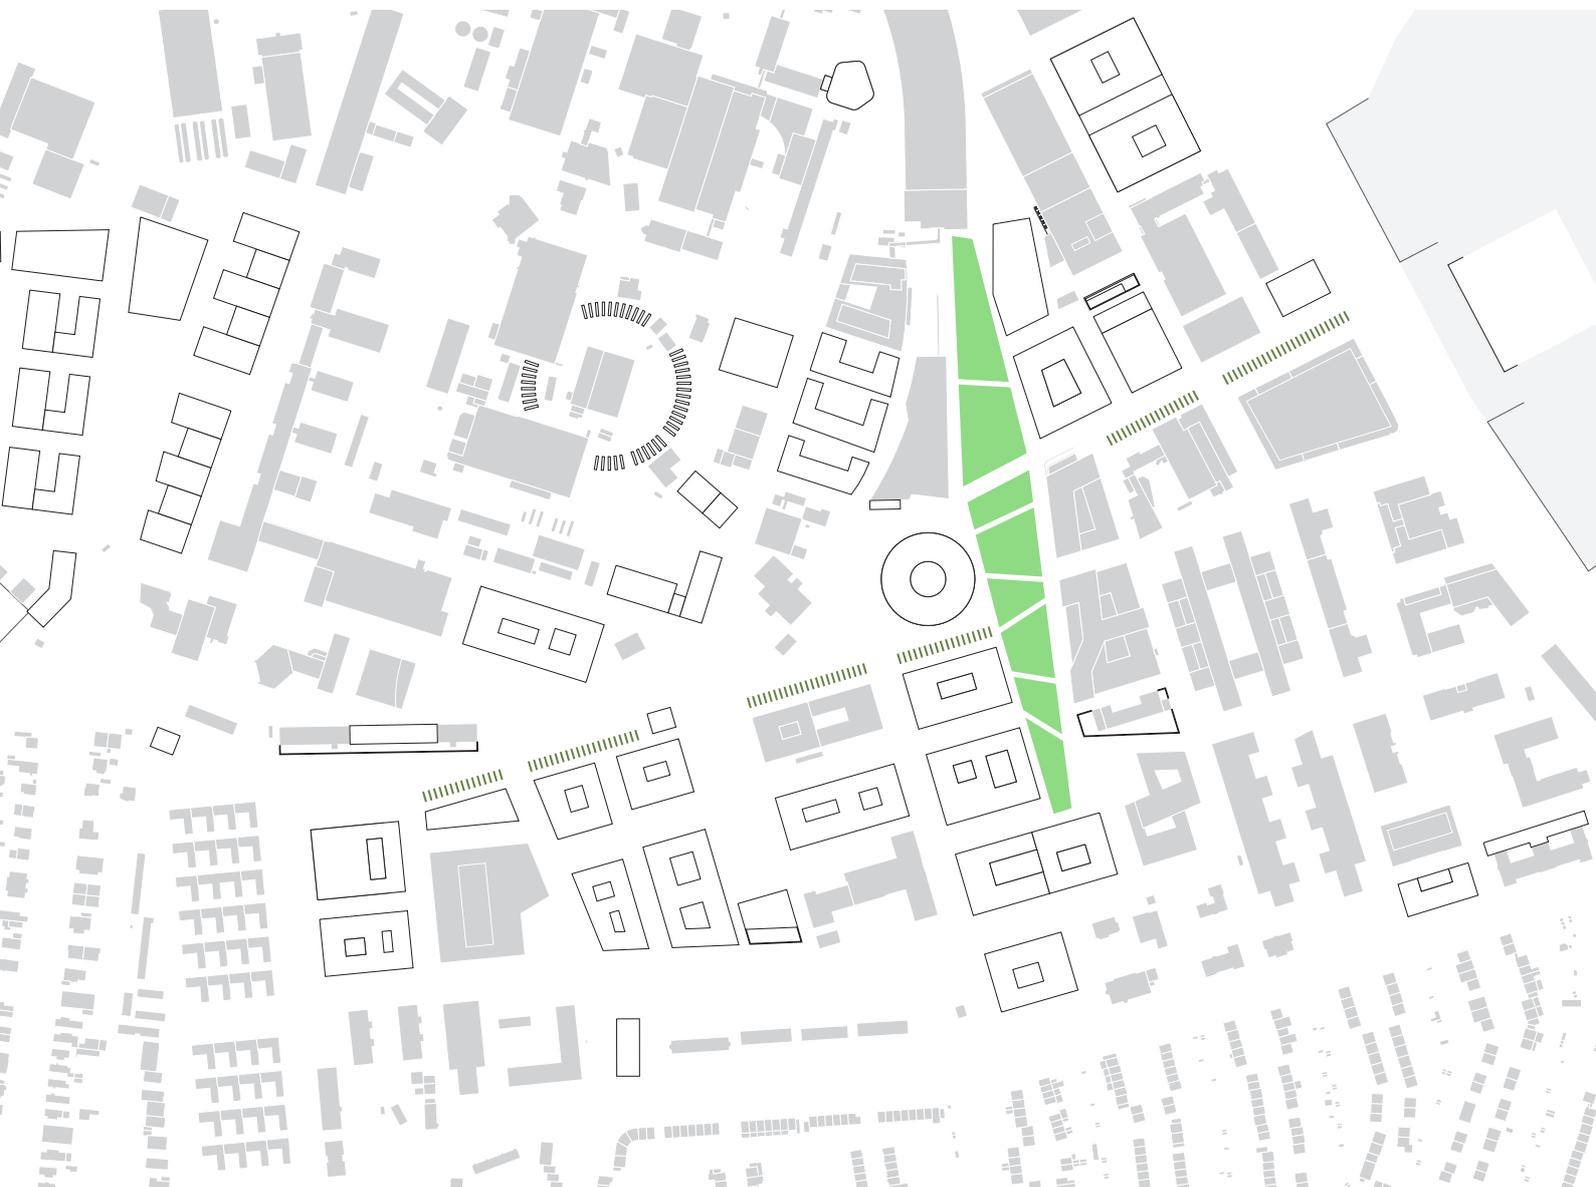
Regel: Ausstattungselemente – Ausschnitt bauliche Struktur, o. M.
